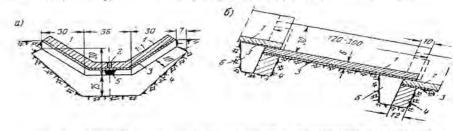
Схема сборных железобетонных секций, укладываемых для укрепления канав и кюветов:
